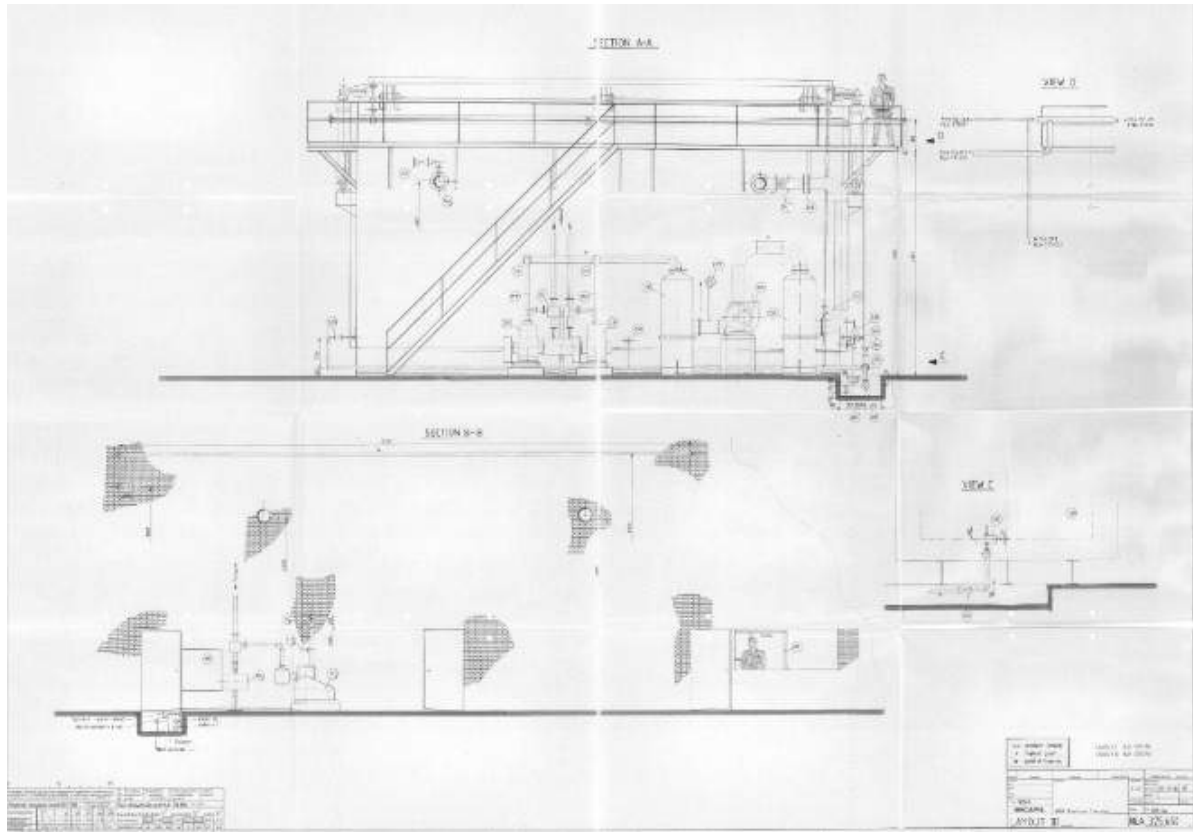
Plano de instalación Vapour Phase. Vista 1.
